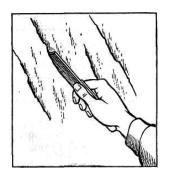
го разряда держит шлифовальное приспособление так же, как прикладывает рабочей его частью обрабатываемой поверхности поступательно - возвратными движениями сглаживает его, передвигаясь по работы вперед. Маляр 3-го разряда легкими движениями кисти вправо и влево сметает пыль с поверхности потолка, отступая по мере очистки поверхности назад. Работа выполняется с пола.
